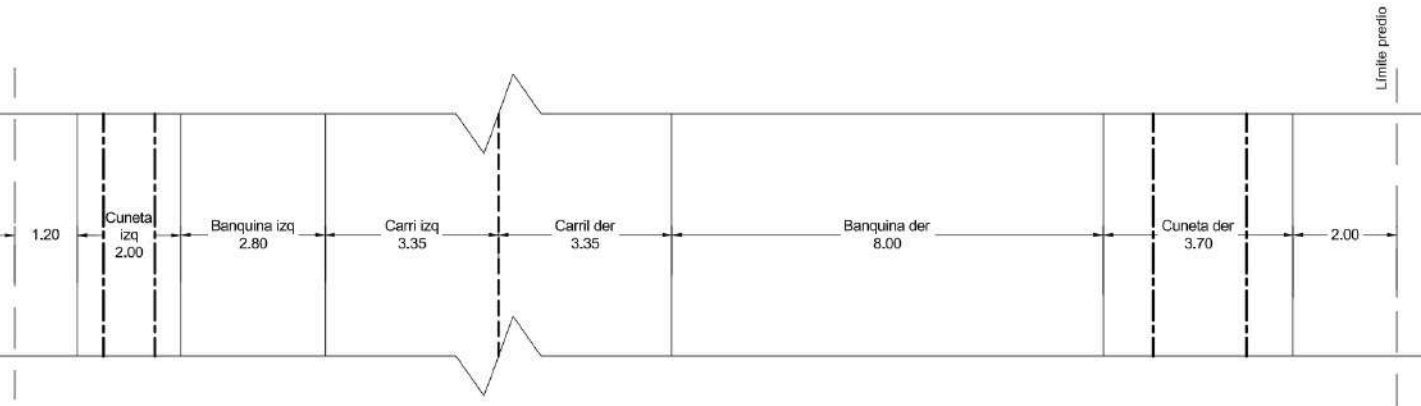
Esquema en planta Ruta Provincial 4S pre proyecto adyacente al camino. (Fuente: Elaboración propia).
